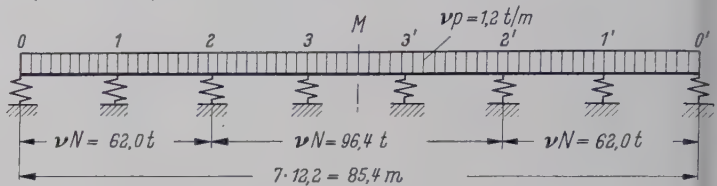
Elastischer gestützter, axial- und querbelasteter Durchlaufträger (Zahlenbeispiel 5)
